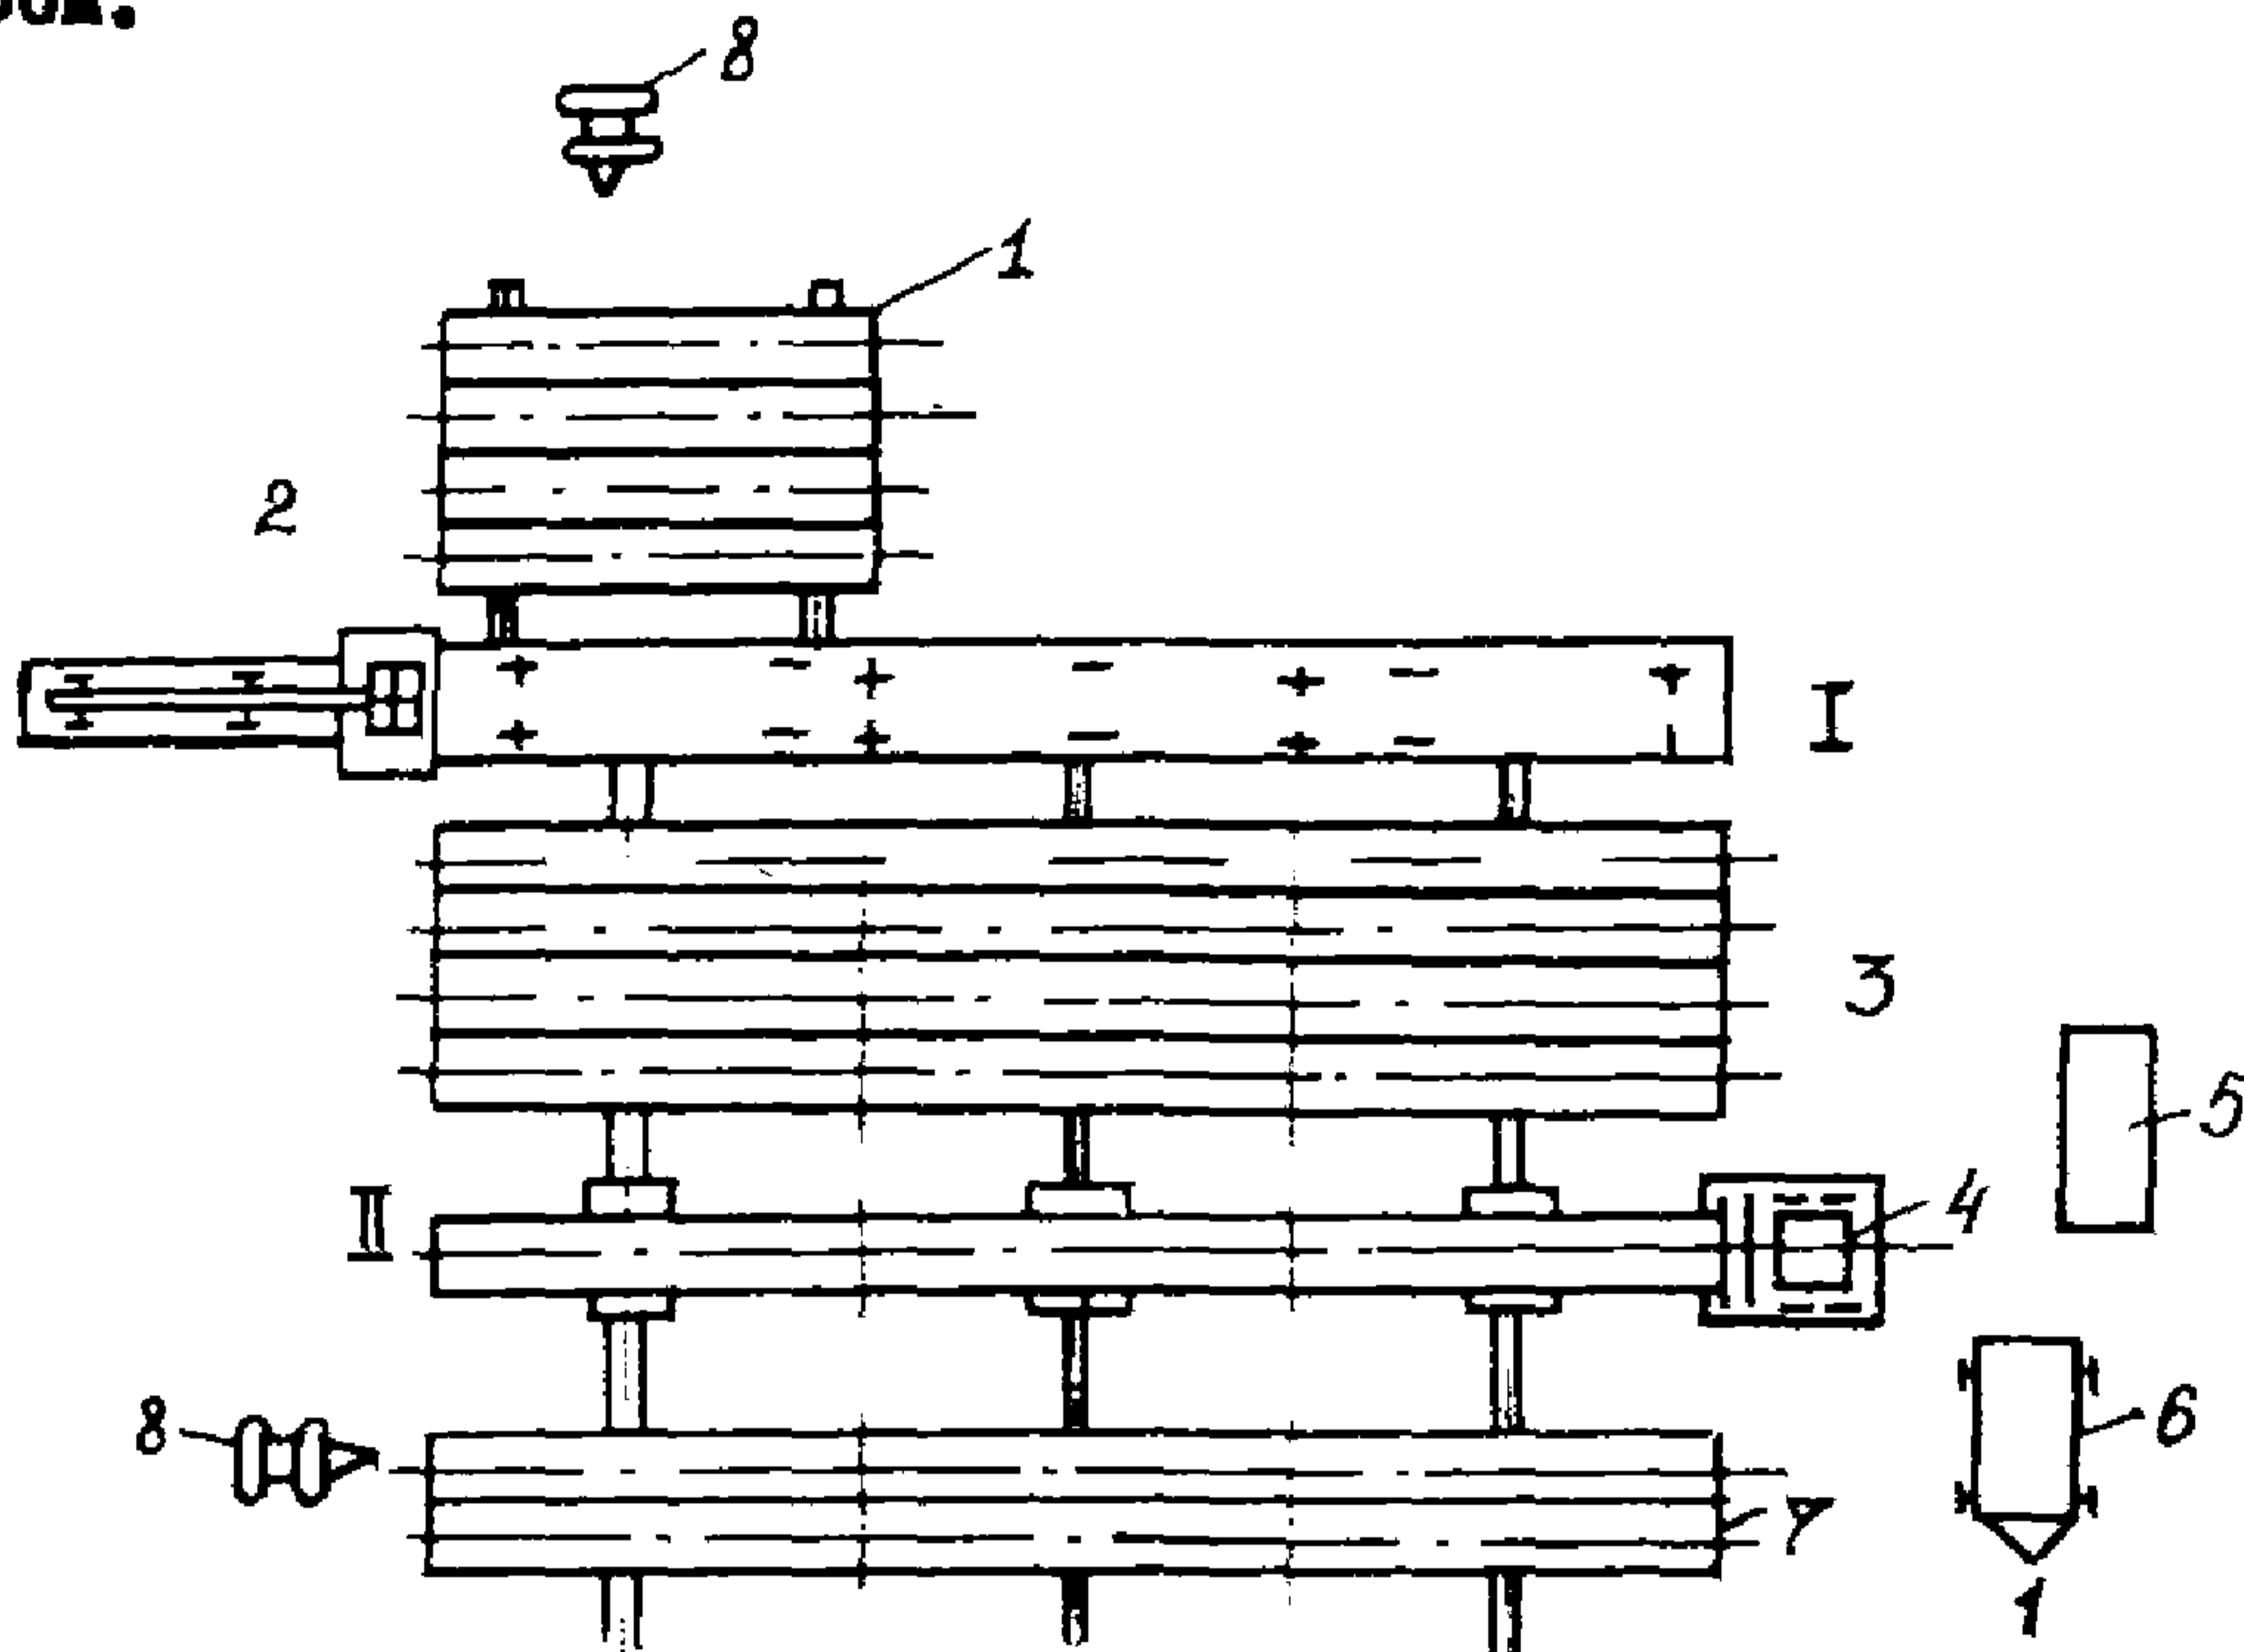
Схема трубосварочной базы с применением ПАУ для сварки под слоем флюса по ручной подварке:
